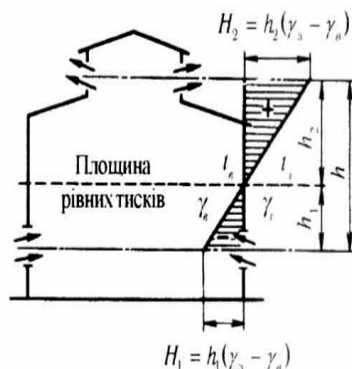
Розподіл тиску повітря у будівлі внаслідок дії теплового напору
